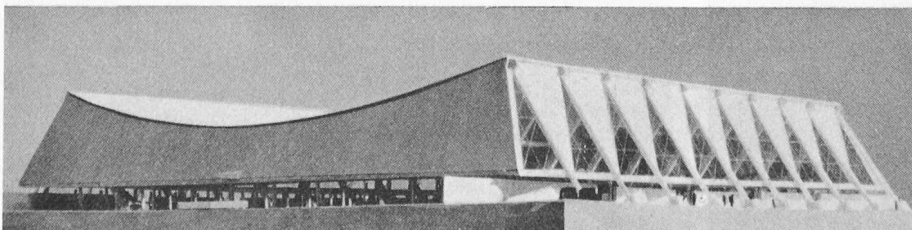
Projekt der Hyspa-Halle in Bern. Hängedach mit vorfabrizierten Dachplatten, welche auf Spannkabeln ruhen. Grundrissfläche rund 90 m × 90 m
